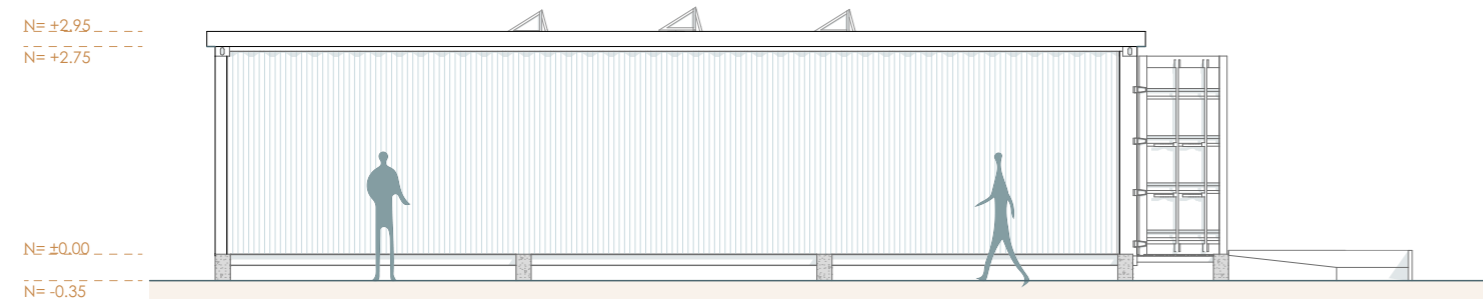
Elevación lateral izquierda vivienda tipo 1.
